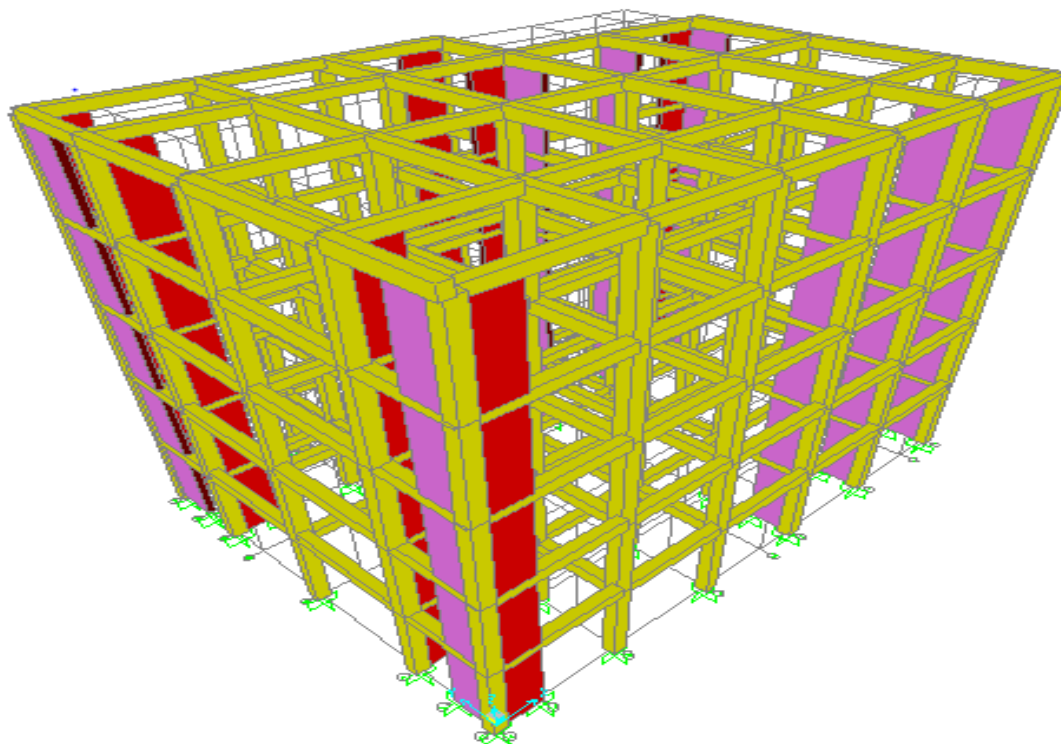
Modélisation de la variante 02 après confortement (2ème disposition) sur SAP2000/V14.
